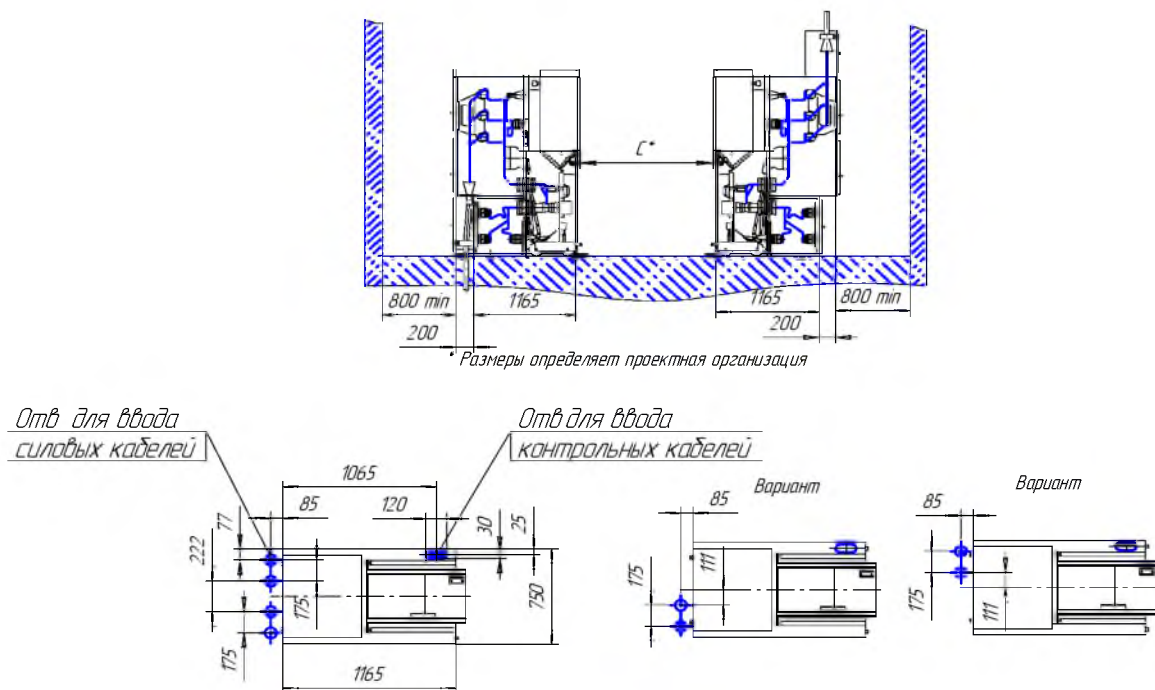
Установка шкафов с кабельным вводом снизу внутри и с кабельным вводом сверху на фундамент
